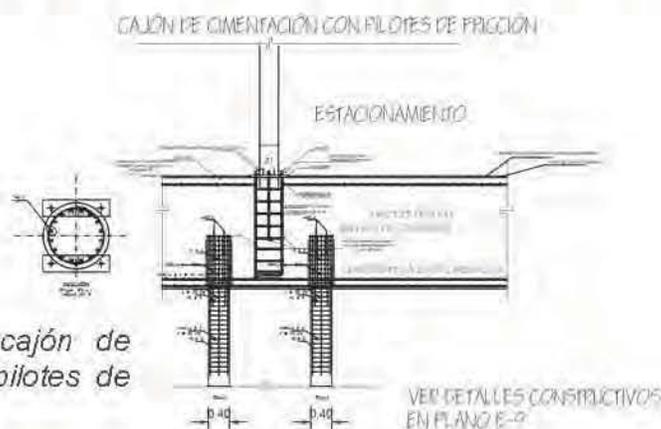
Corte cajón de cimentación con pilotes de fricción.
